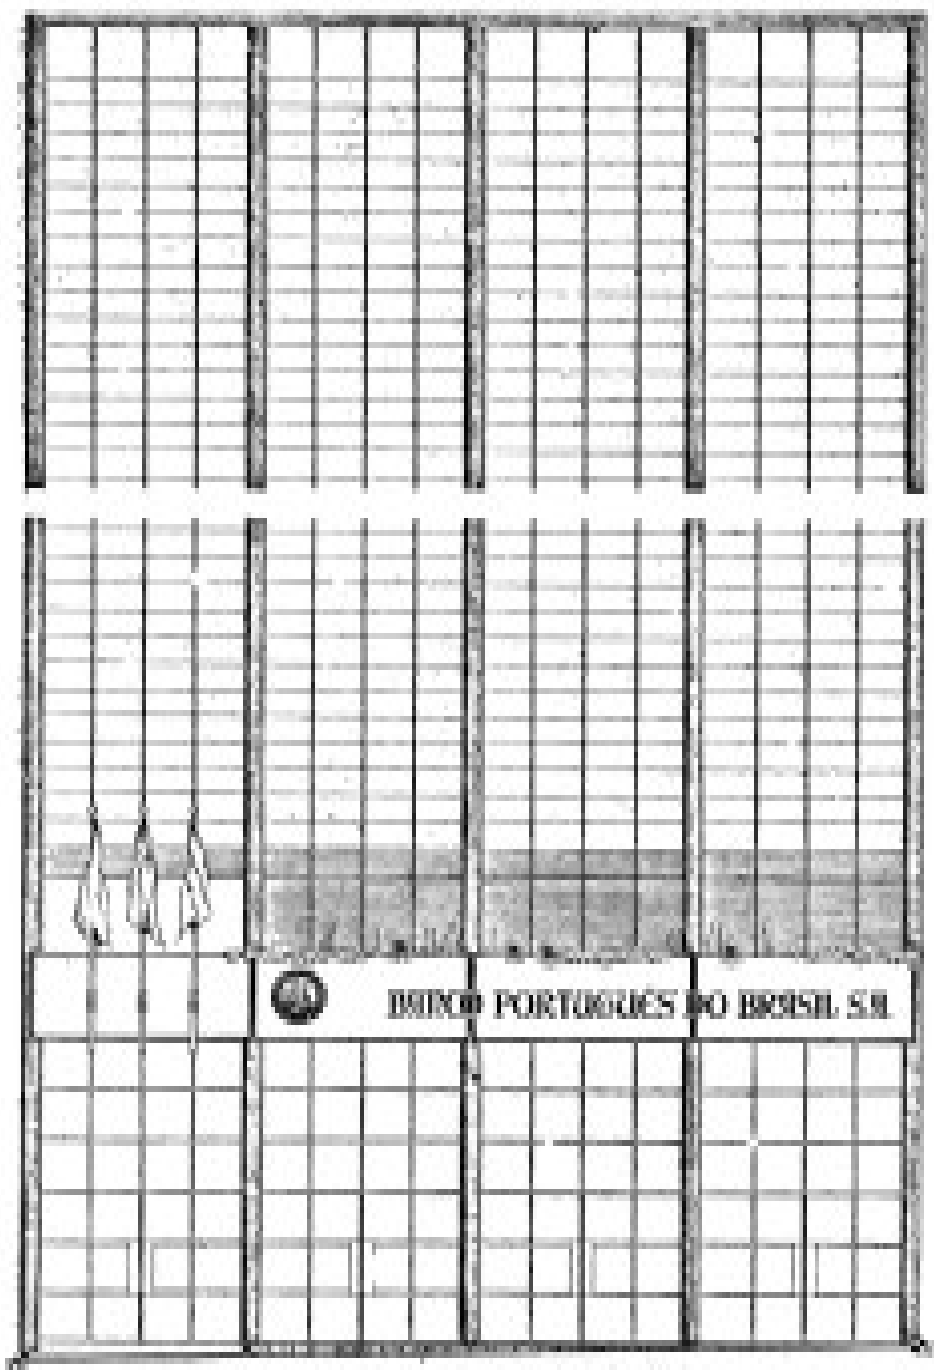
Fachada para a rua Primeiro de Agosto: Edifício Caravelas projetado por Pinho em 1967.
